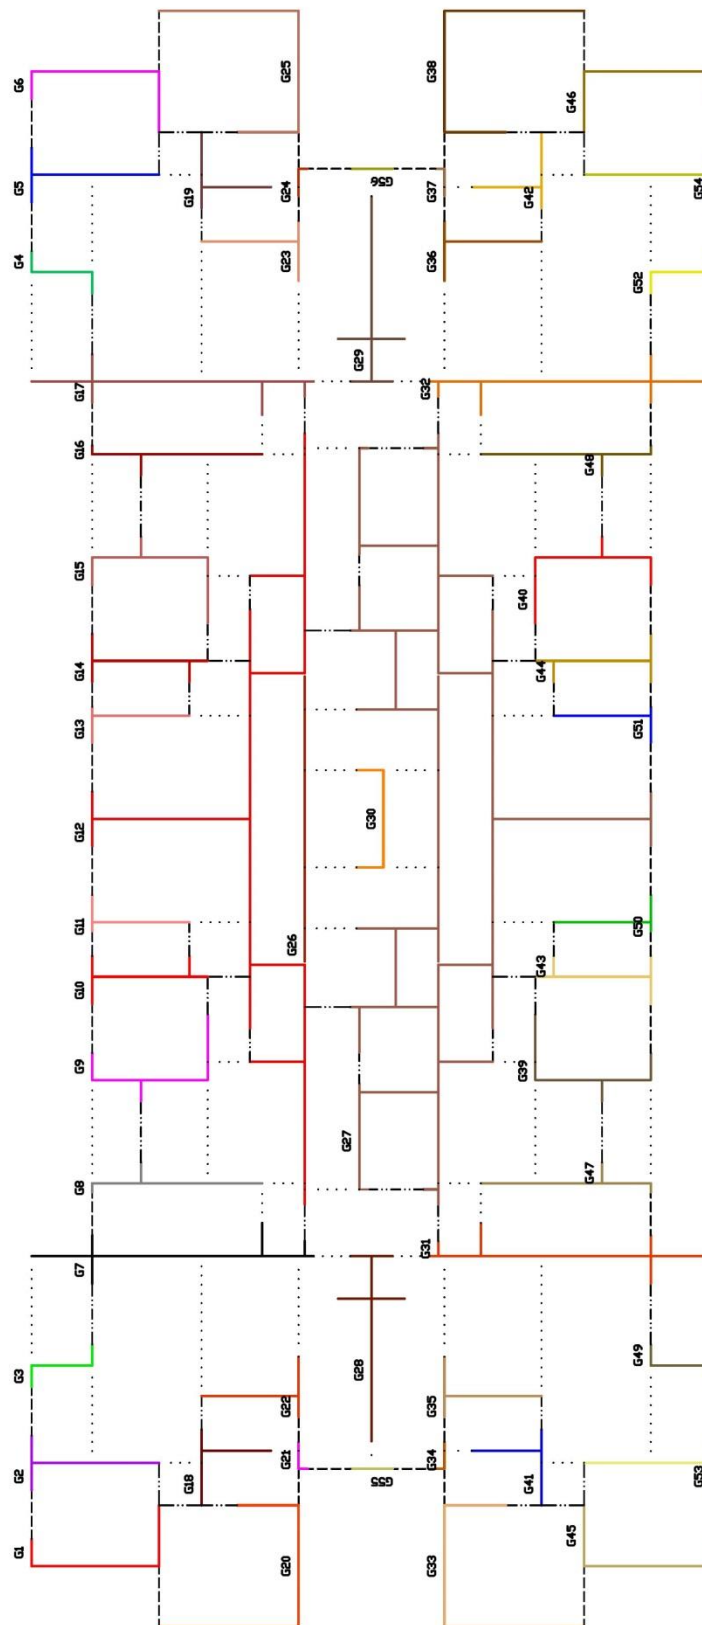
Edifício Way Penha: grupos de paredes isoladas para ações verticais
